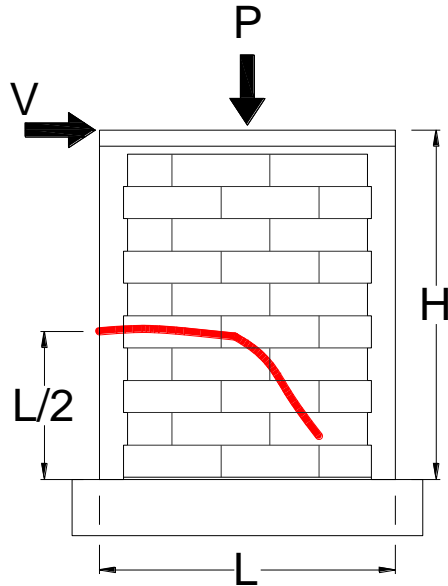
Grieta de flexo-cortante en un muro confinado.
